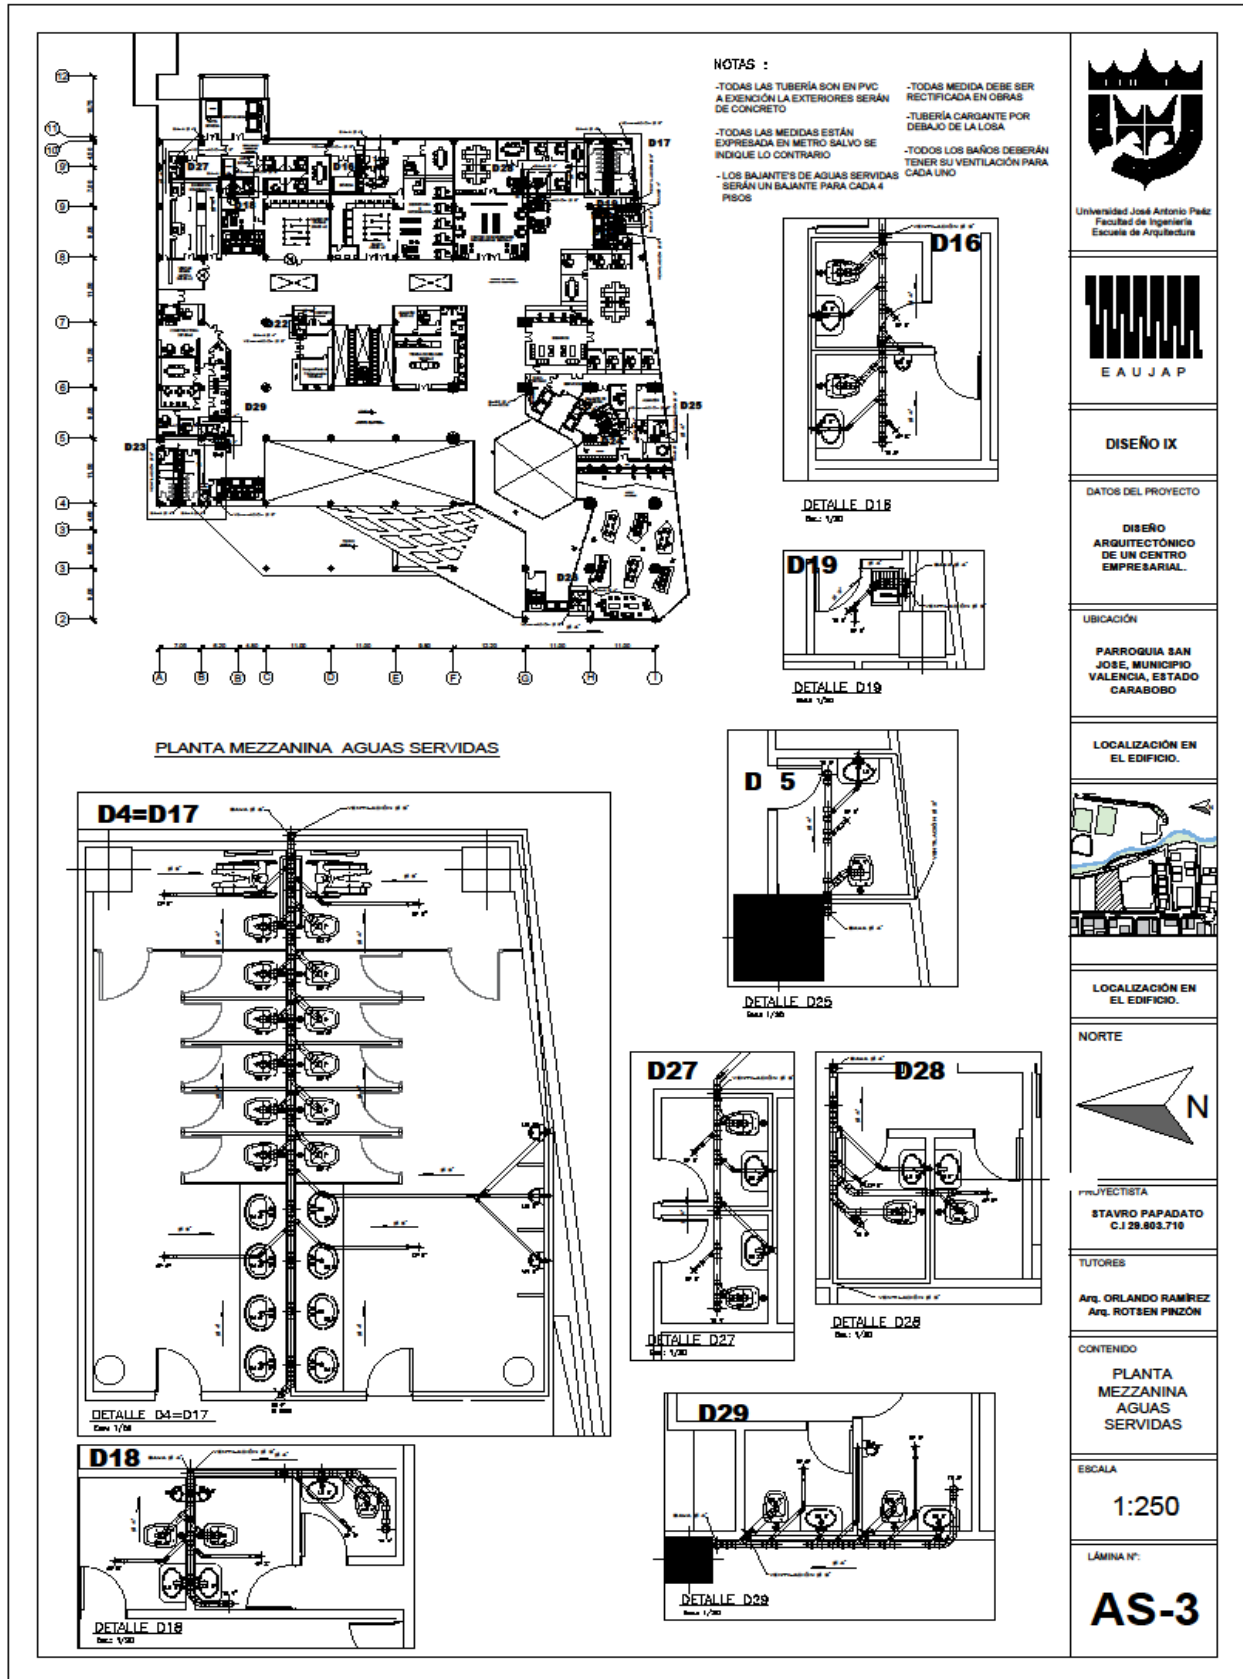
AS-3 Planta Mezzanina Aguas Servidas. Fuente: El Autor(2023)
